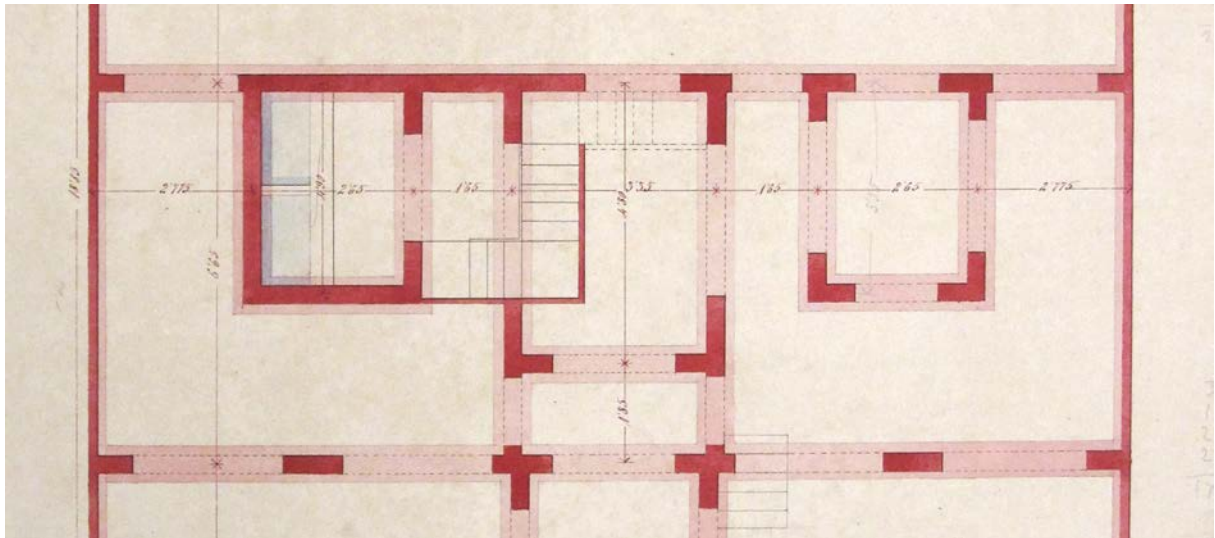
Detall de planta soterrani (casa Josep Añés, arquitectes Bassegoda, 1881). Font: AHCOAC H121D/7/501.21.
